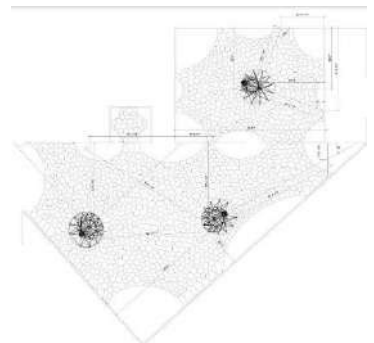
| “*Lumen*”, Planta de implantação (Fonte: Sabin, J. (2019). *Lumen*. White Papers, p. 291–317).
